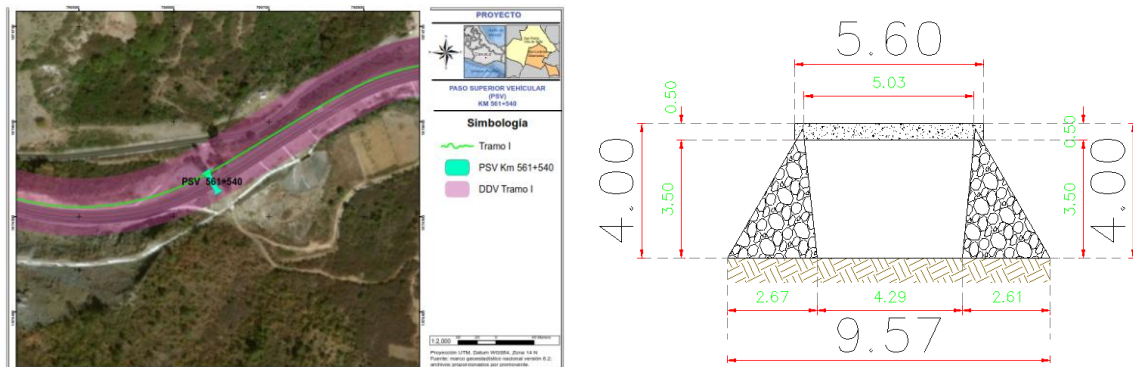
Proyecto en planta y corte transversal del PSV 561+540.
